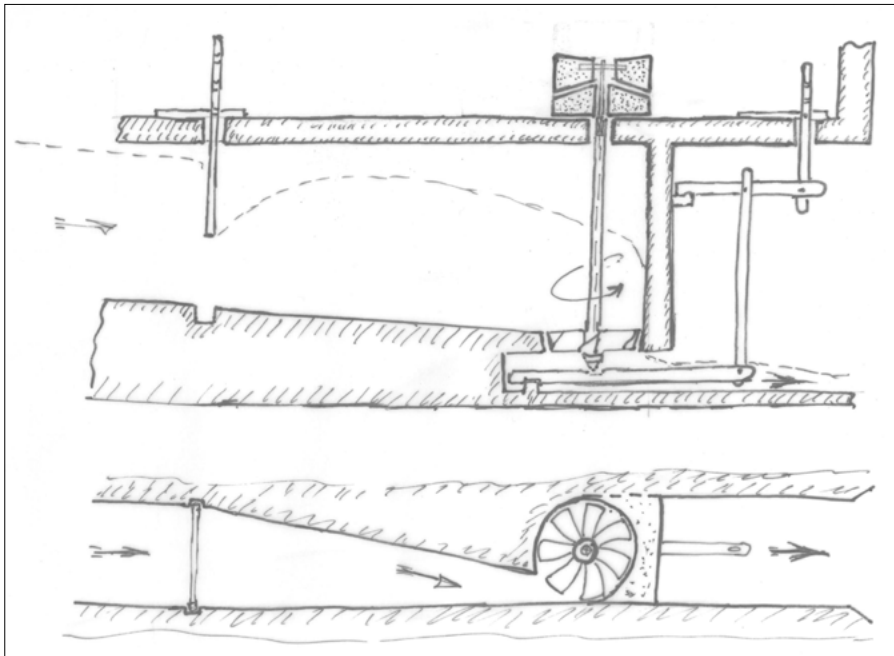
Turbina ad asse verticale, sezione e pianta (Rakob 1993 ridisegnata)
